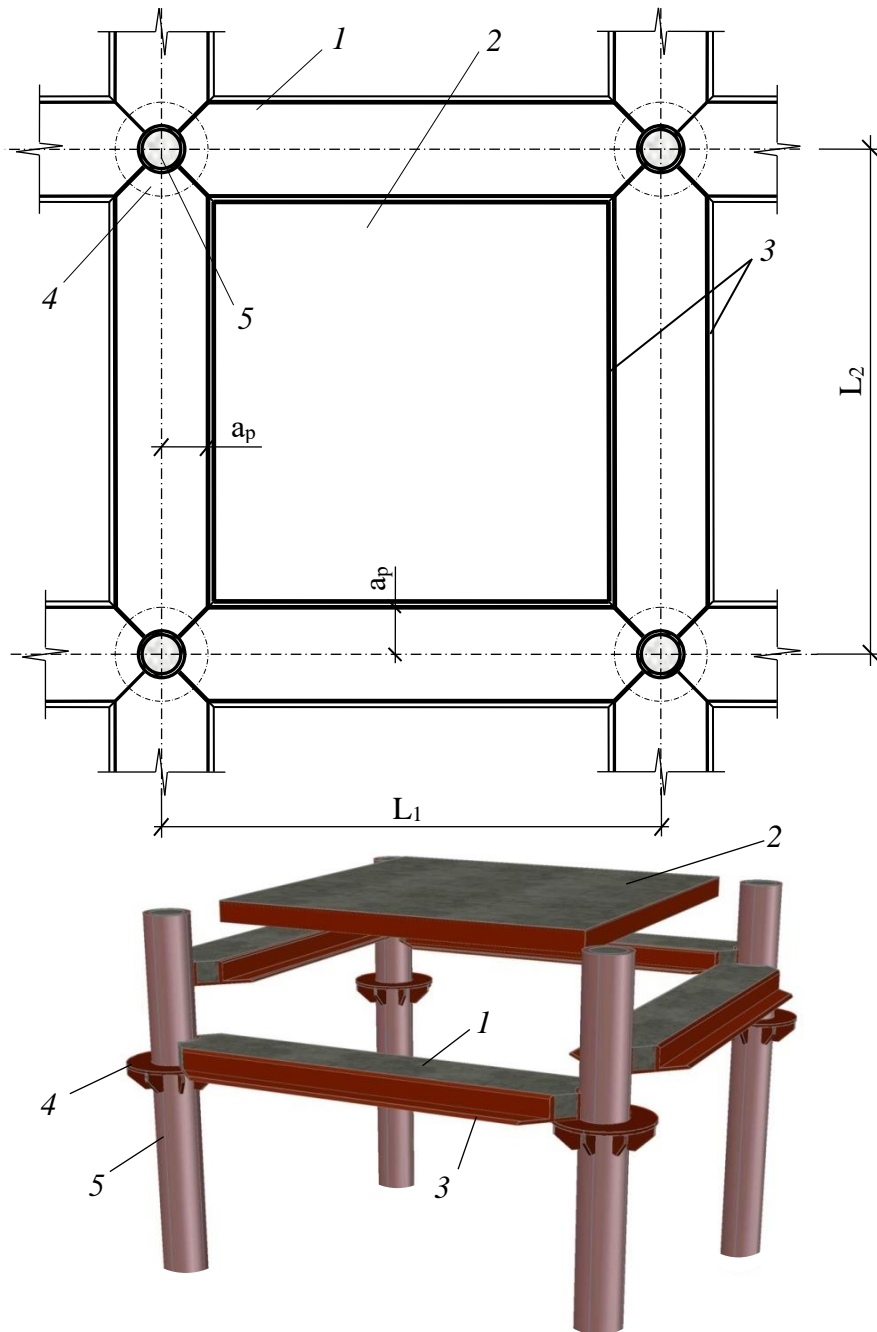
Фрагмент збірного сталезалізобетонного безбалкового перекриття з плитою-вставкою системи С:
